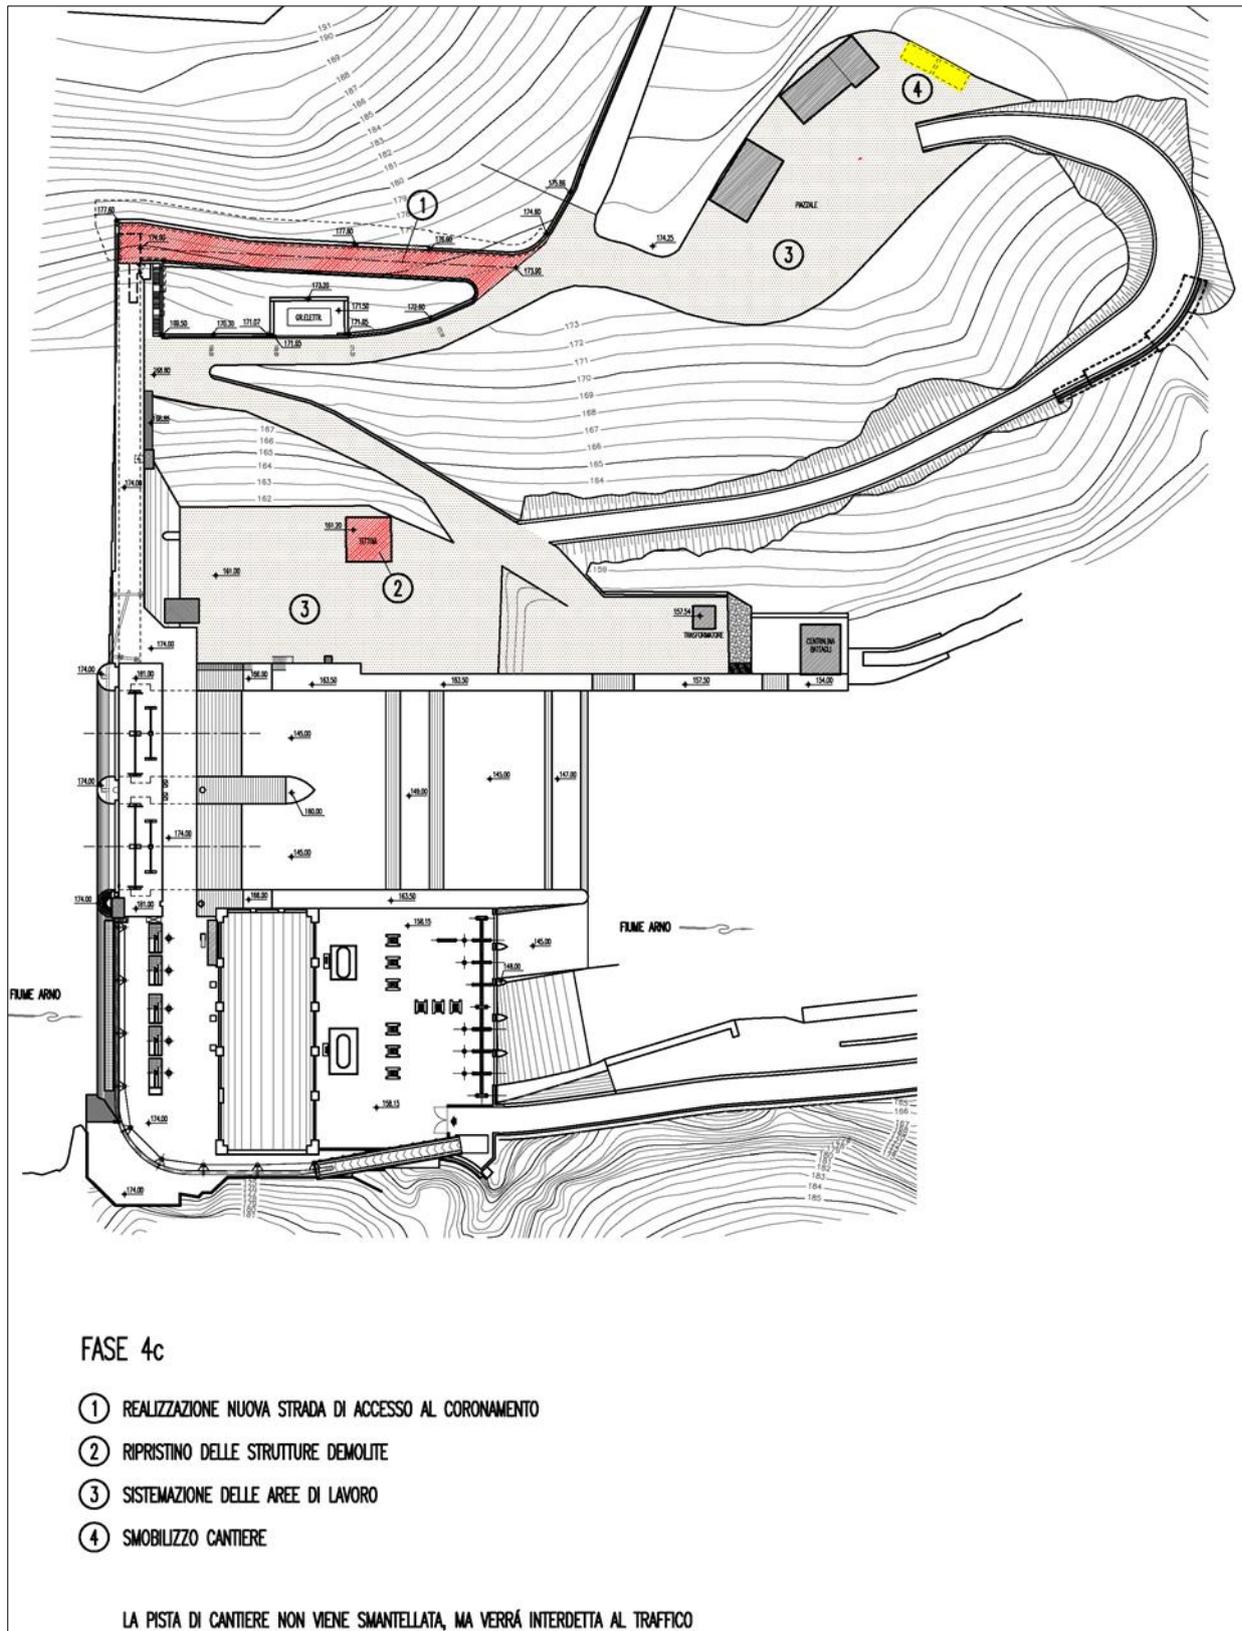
stralcio planimetrico con indicazione degli interventi nella fase 4(c)
